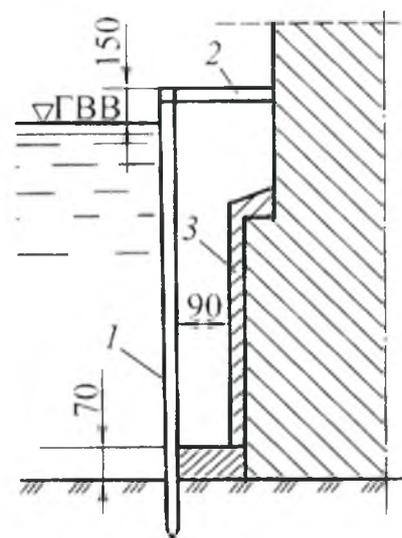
Усиление подводной части кладки опор: 1 — шпунтовая перемычка; 2 — распорка; 3 — железобетонная рубашка
